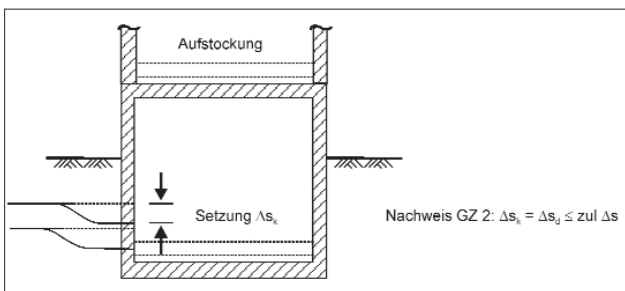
Nachweis der Gebrauchstauglichkeit am Beispiel der Zerstörung einer Hausanschlussleitung durch zu große Setzungen infolge nachträglicher Aufstockung eines Gebäudes
